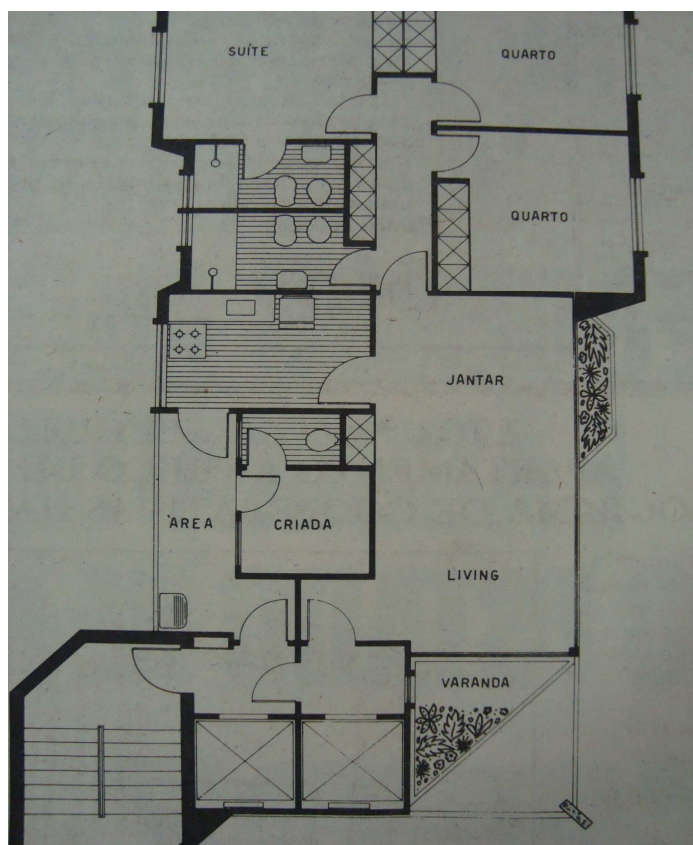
Planta de Apartamento com duas entradas social e serviço.
